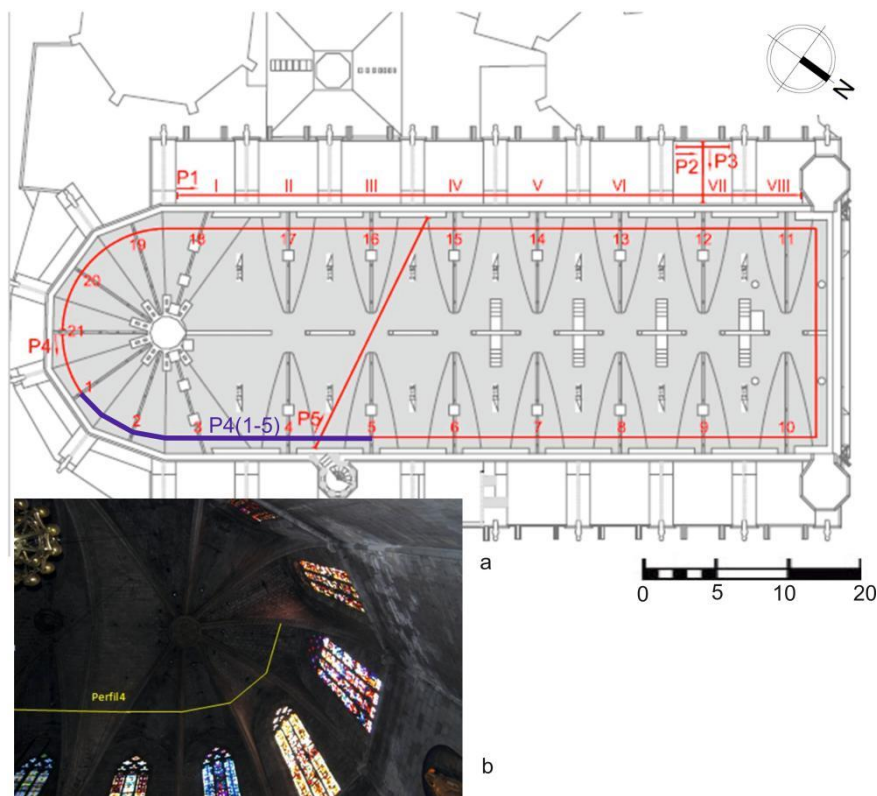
5: Trazas de radargramas en la cubierta de la basílica de Santa María del Pi (Barcelona). a) Plano en planta y posición del perfil P4 utilizado para ilustrar el procesado de radargramas; b) Fotografía interior de la cubierta con el perfil P4 proyectado.
